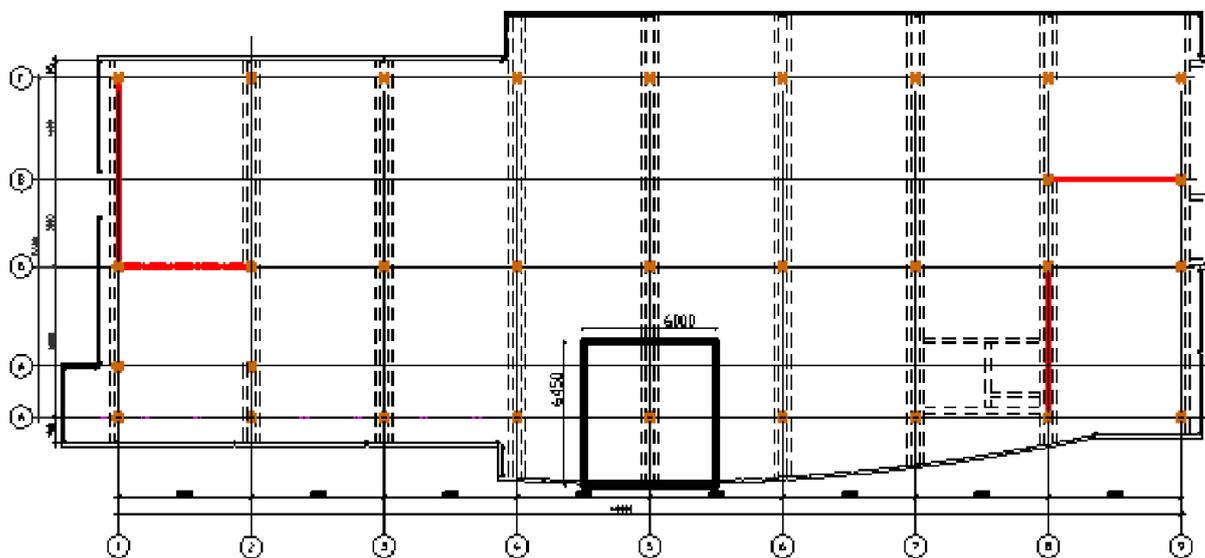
Грузовые площади фундамента на отм. 4,800 по оси А-5.
